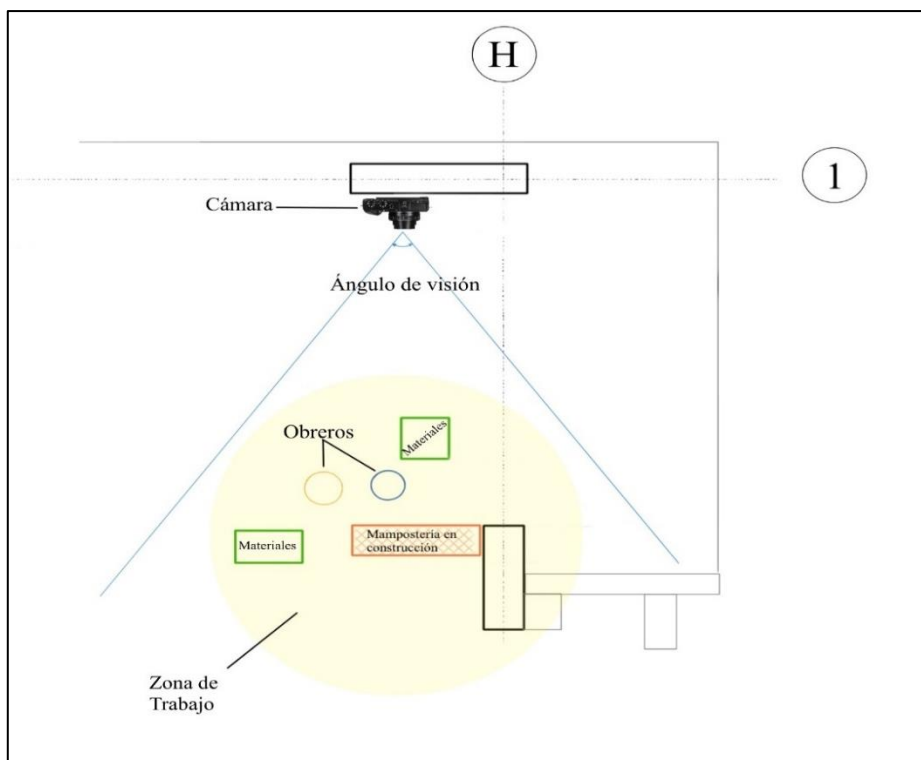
Ilustración ubicación cámara con respecto a la zona de trabajo del rubro mampostería de bloque.
